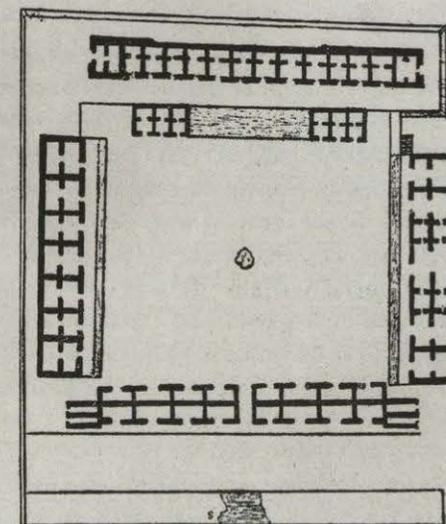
Planta del palacio llamado Casa de las Monjas. Uxmal.
